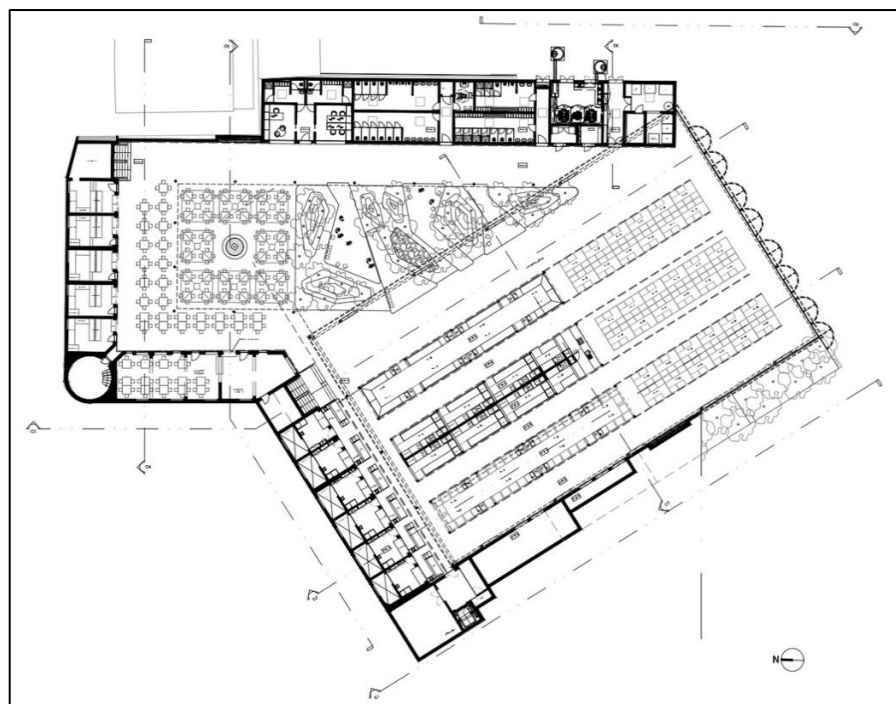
Planta Baixa do bloco existente e anexo da proposta de ampliação do mercado.
